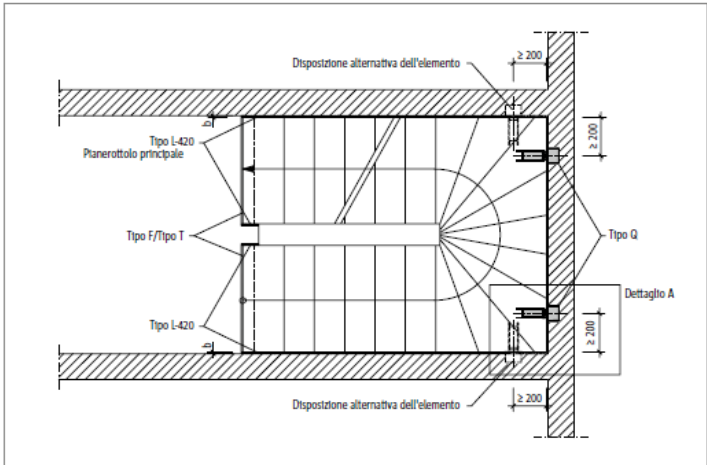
Schöck Tronsole® tipo Q, disposizione dell'elemento nella pianta mediante Tronsole® tipo L
